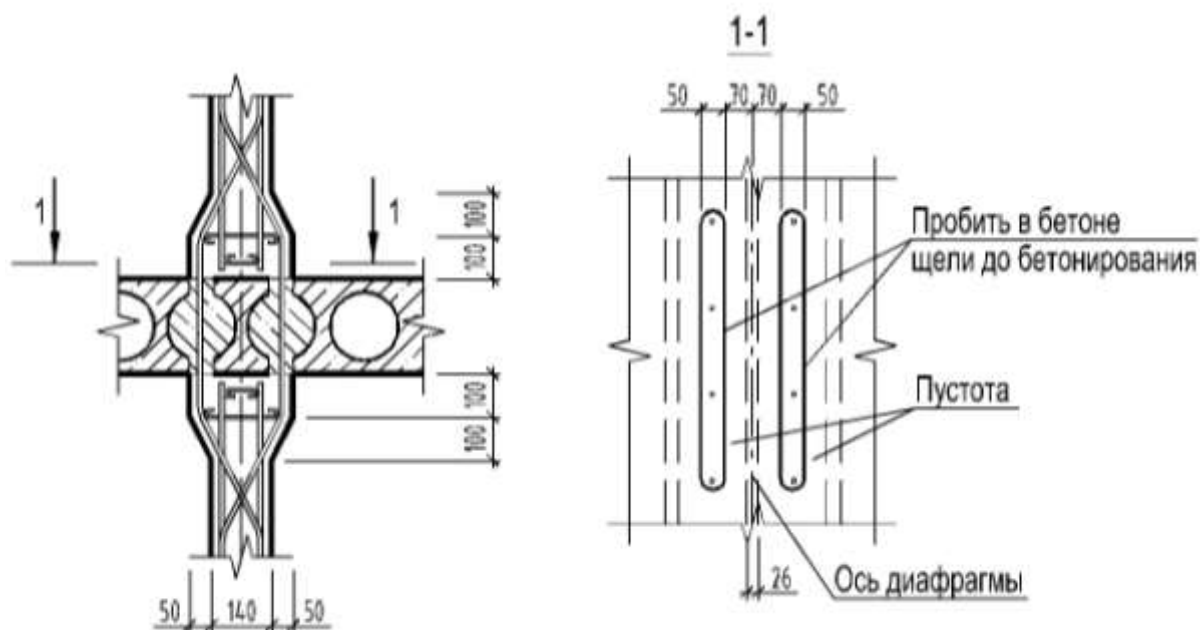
Соединение диафрагм продольного направления с перекрытием из многопустотных плит
